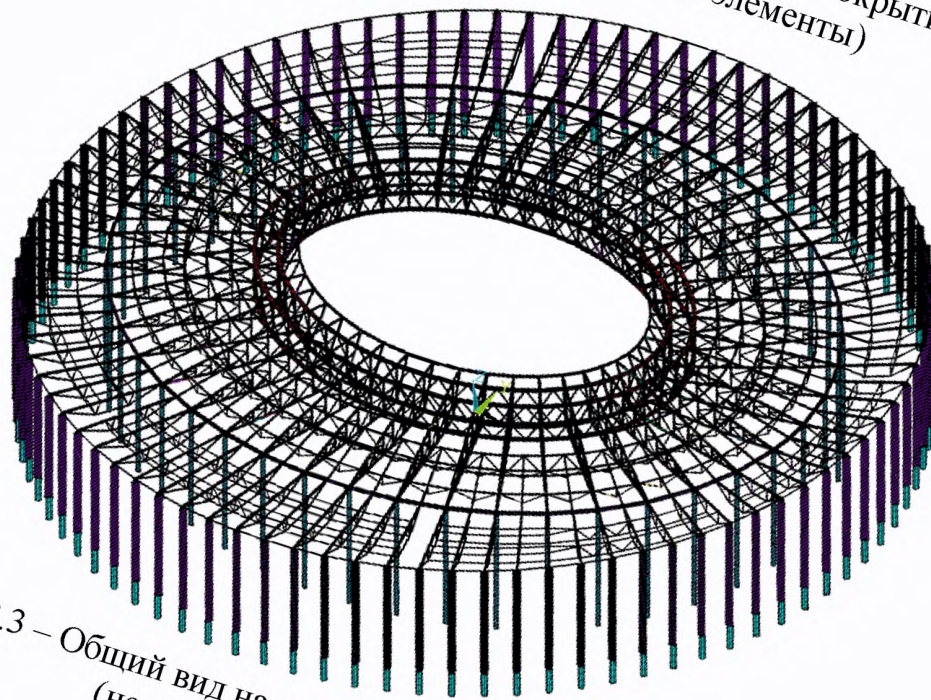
Общий вид на расчетную модель покрытия с колоннами
